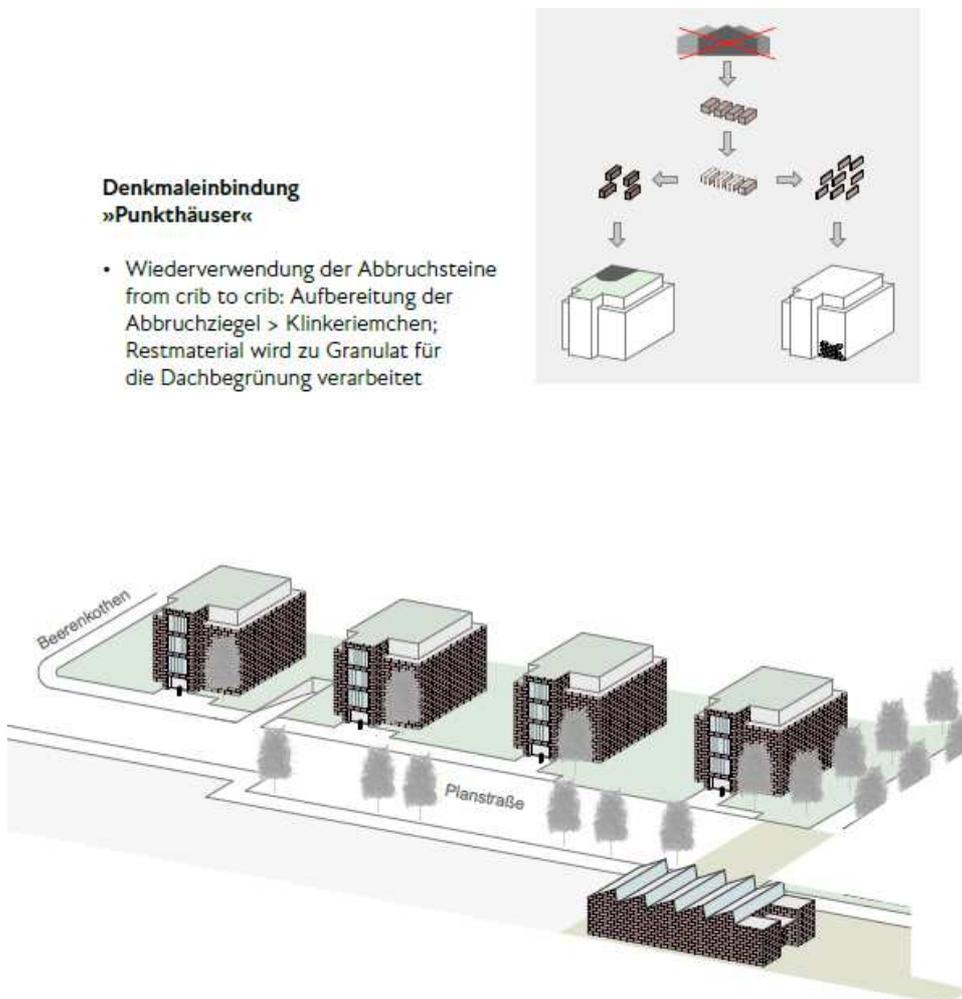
Fassadengestaltung Punkthäuser „Planstraße“ (Wiemer Architekten, November 2020)
